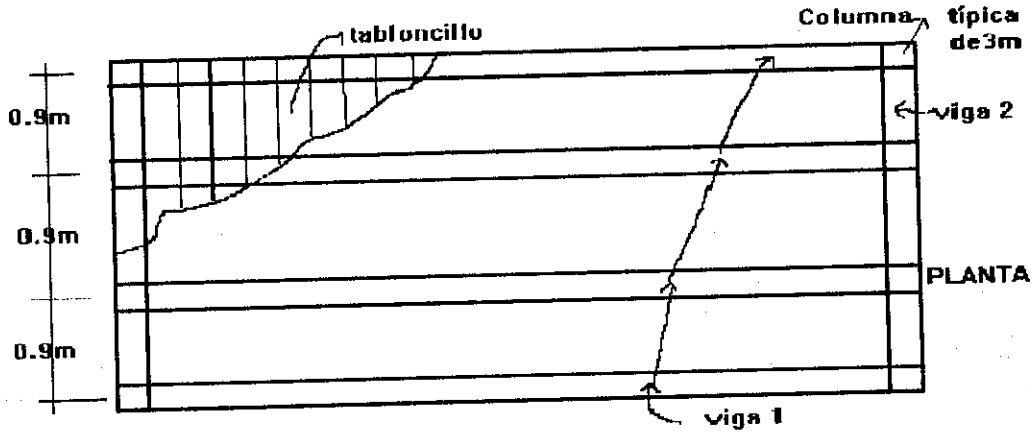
PLANTA ESTRUCTURA DE MADERA (Sin escala)
